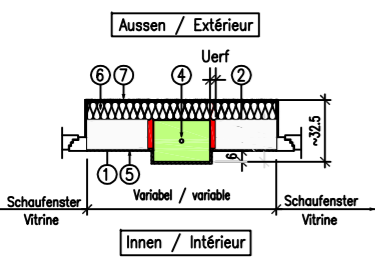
Stahlbetonstützen der Fassaden Nord/Süd/Ost/West im Erdgeschoss und Zwischengeschoss
